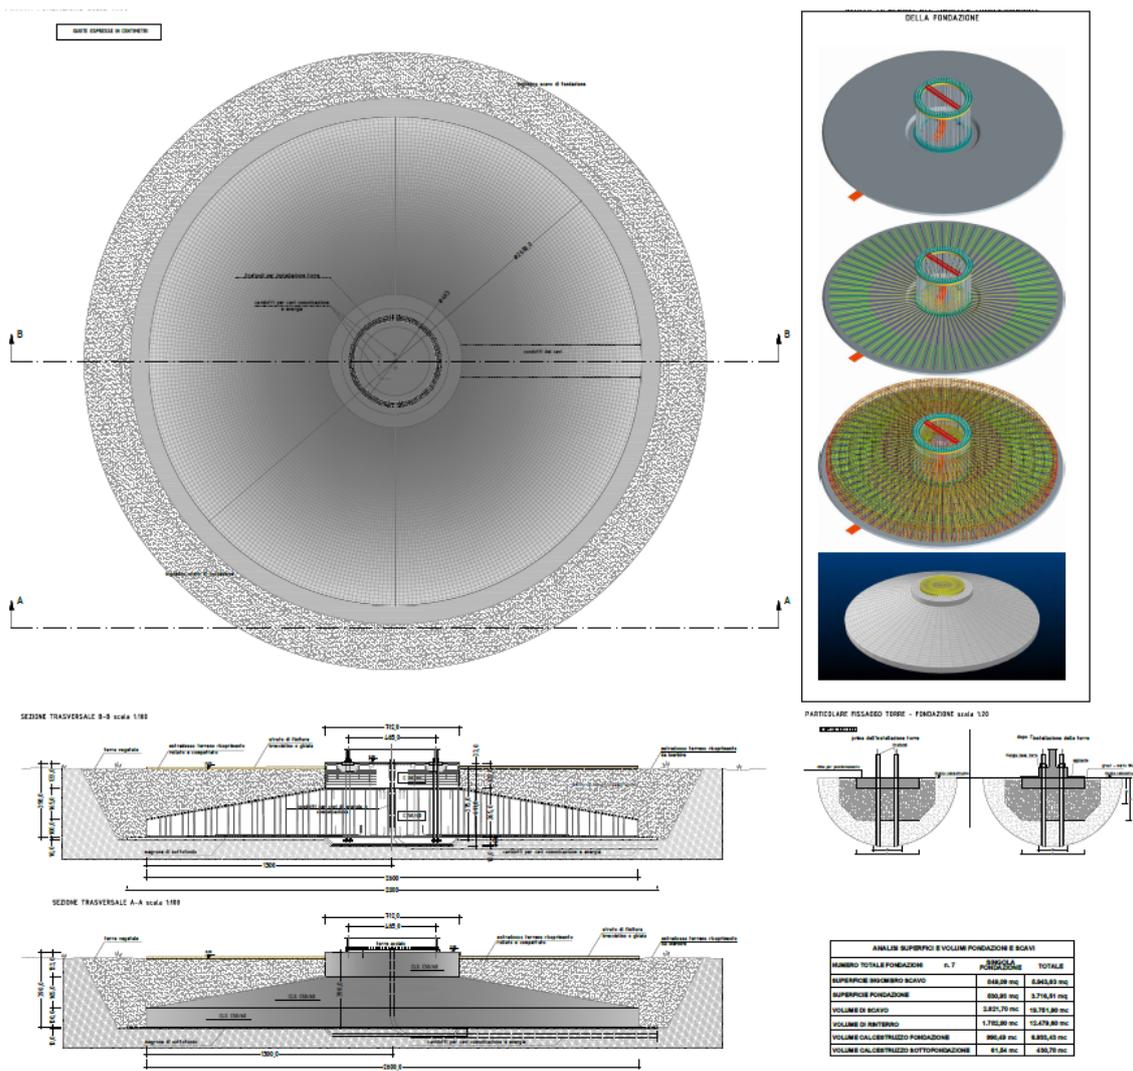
PIANTA E SEZIONE FONDAZIONE
